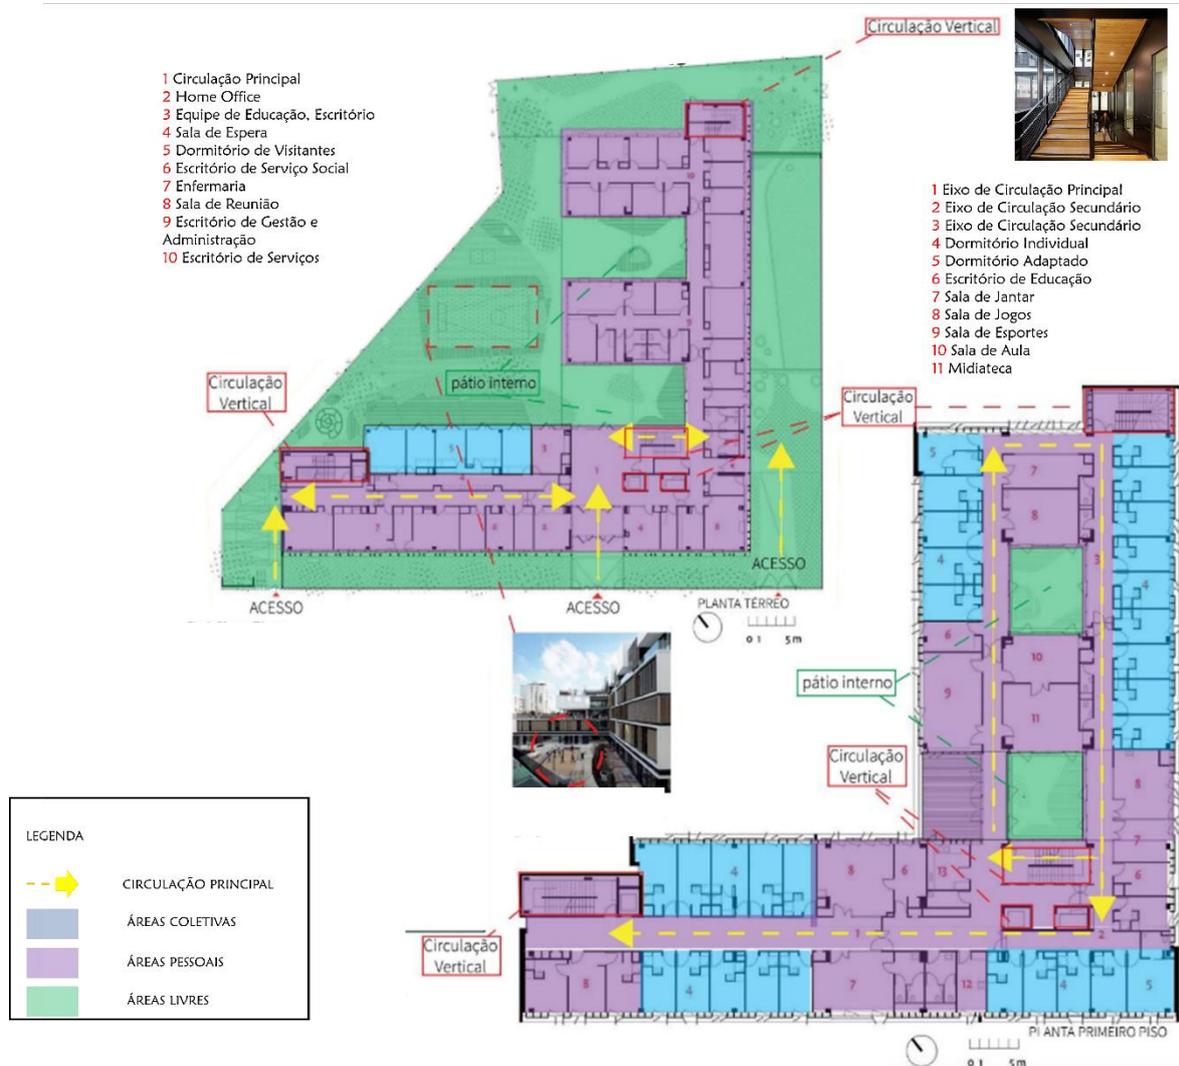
Estudo Projetual. Planta Térreo e Primeiro Pavimento.
